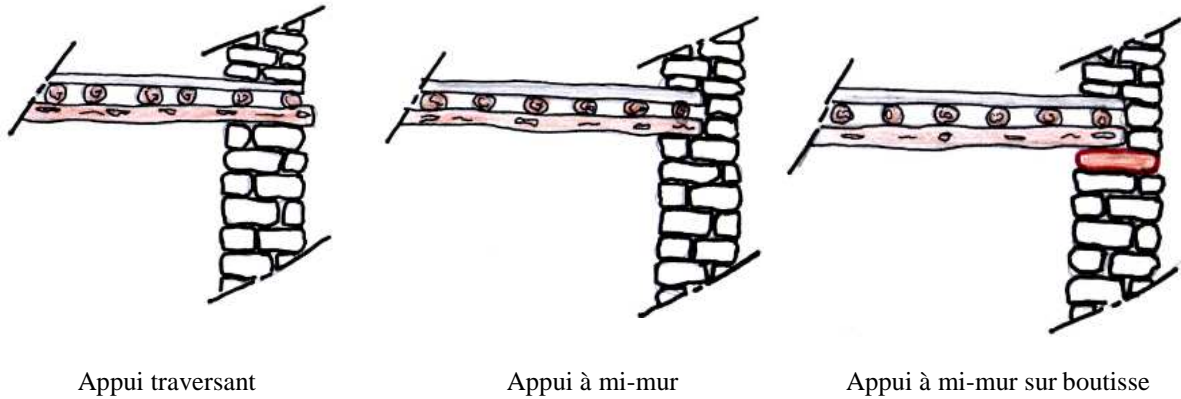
Appuis des planchers. (Source : Coignet.J).
